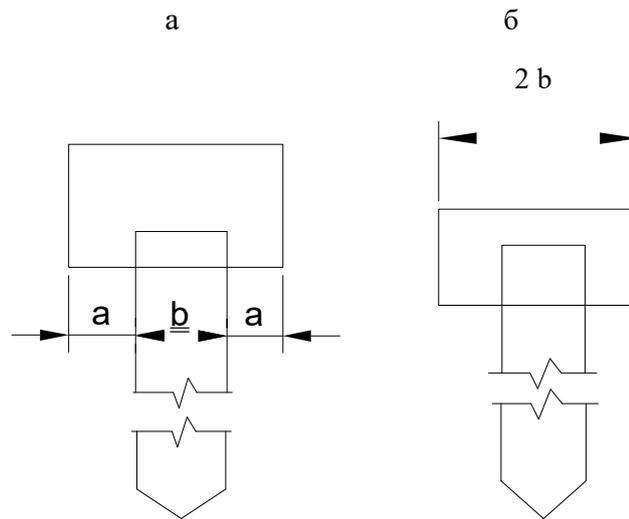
К расчету ширины монолитного ростверка свайного фундамента: а – свободное защемление; б – жесткое защемление
